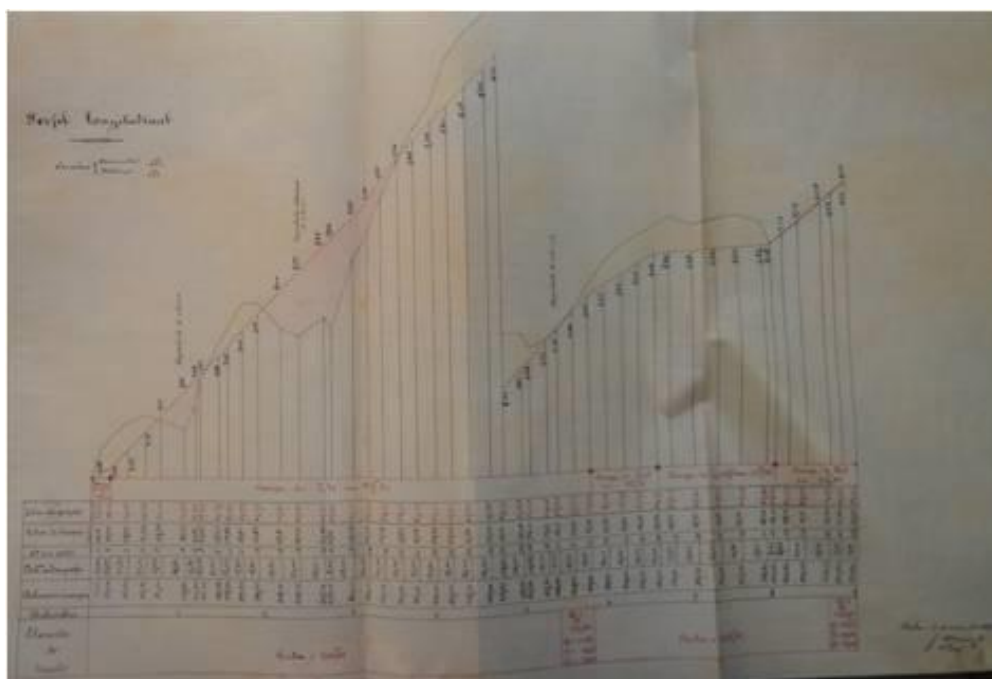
Plano do perfil longitudinal do projeto da avenida 1.º de Dezembro, com as cotas do projeto e do terreno, e os elementos do traçado. 1917 | AMS|FCMS/L/B/09/Cx_04.
